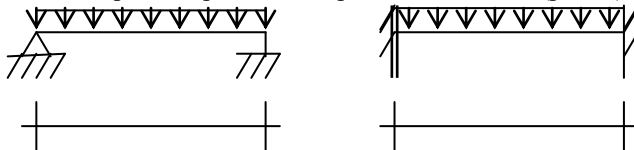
Расчетные схемы плиты перекрытия при различном опирании
